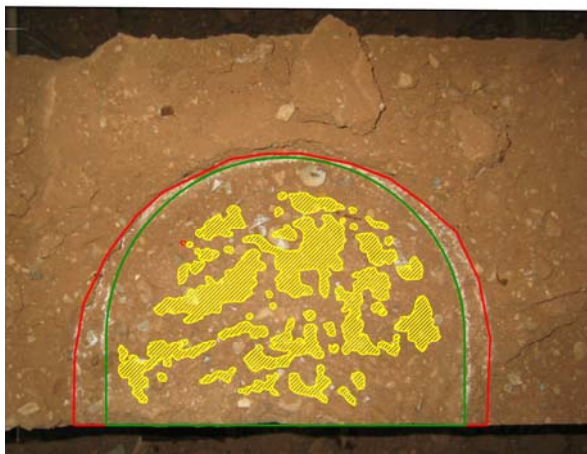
y 4.5.171: Replanteo del área de la roza (896.58 cm²), el área del gato plano GPS-A Inferior (778.56 cm²) y el área de contacto entre el gato plano del ensayo y el muro (186.81 cm²).
